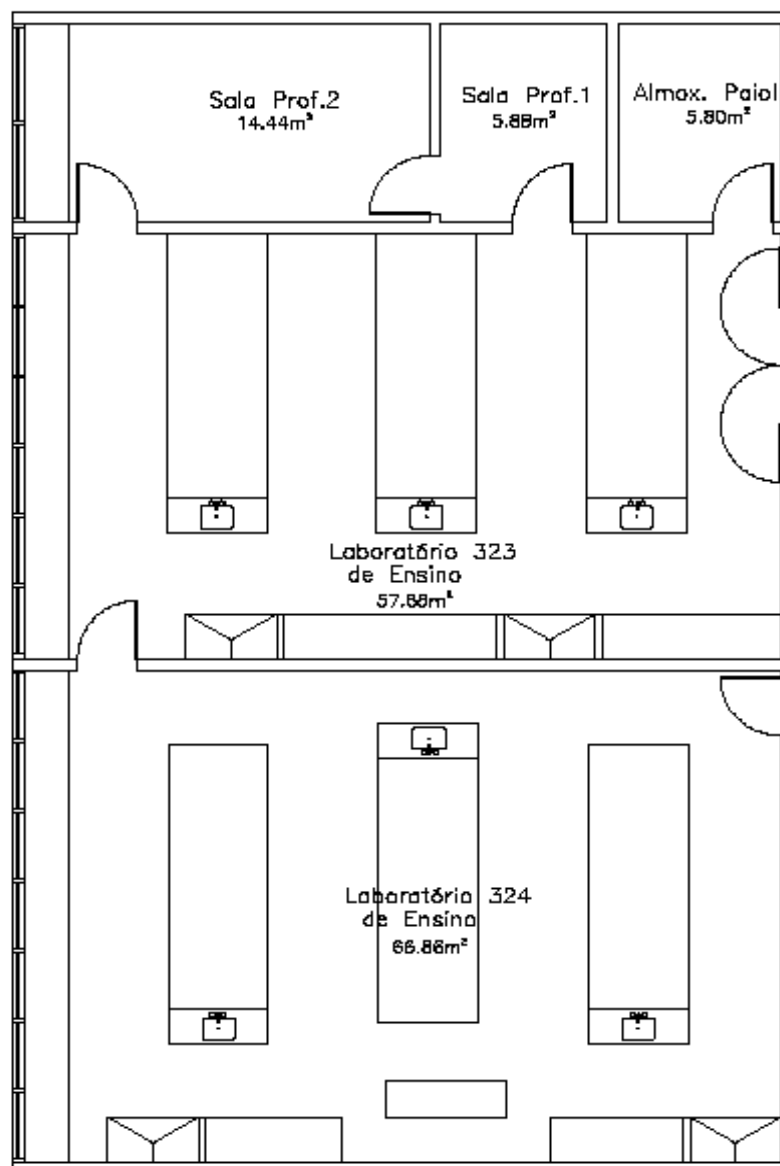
Planta baixa do 3º andar do Pavilhão Reitor Haroldo Lisboa da Cunha
